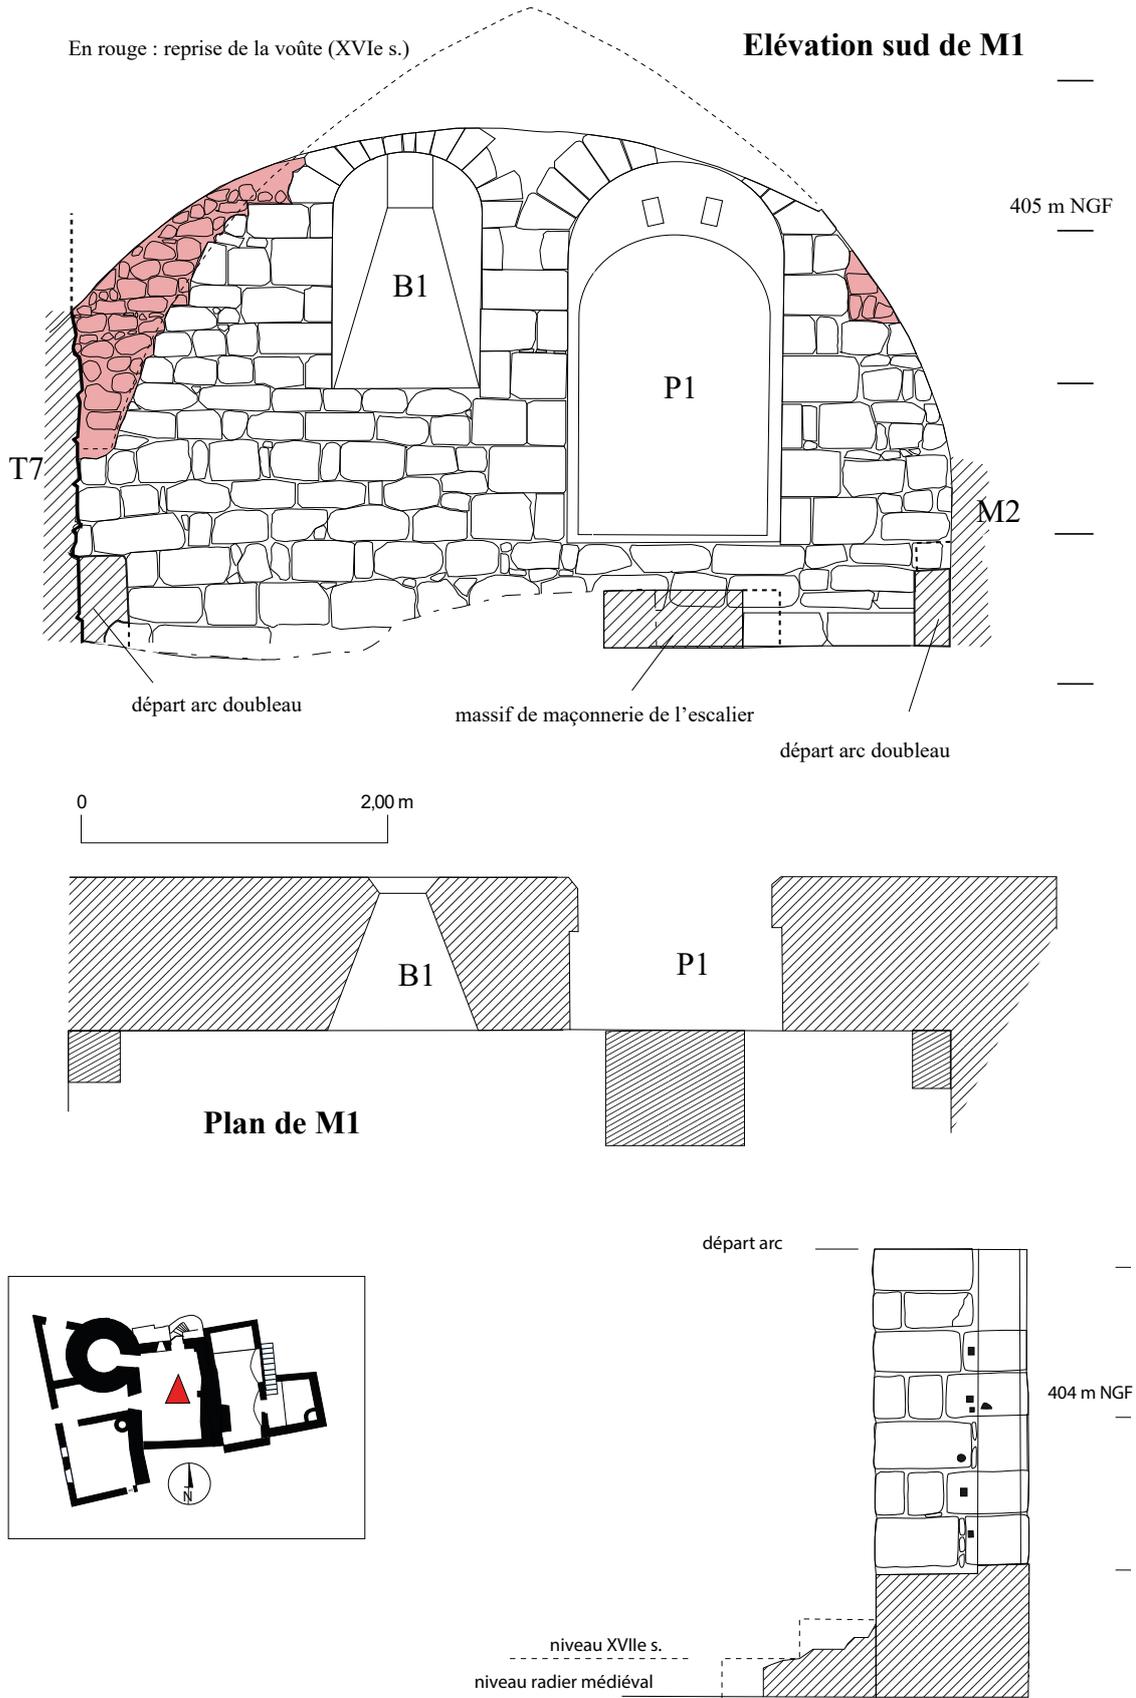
plan, coupe et relevés du mur M 1 (L 1).
